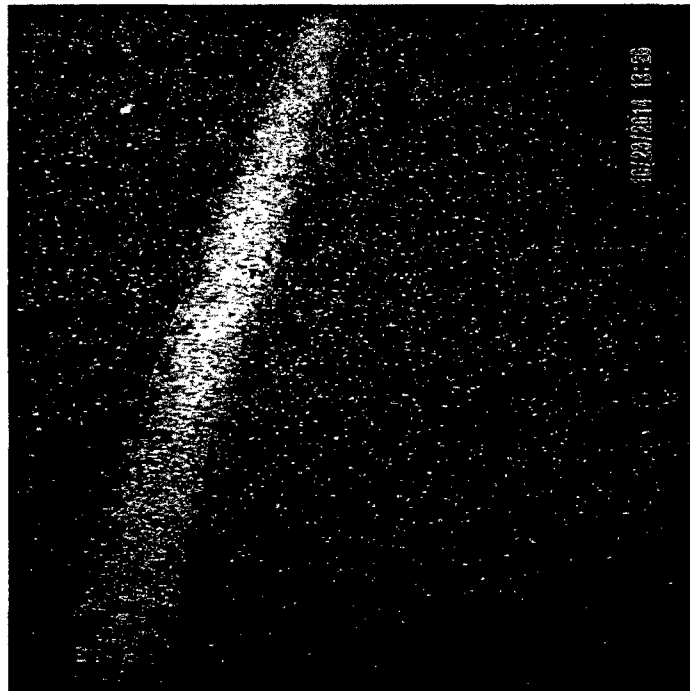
Grietas transversales y longitudinales de baja severidad, de la unidad de muestra U16, sección 1.
